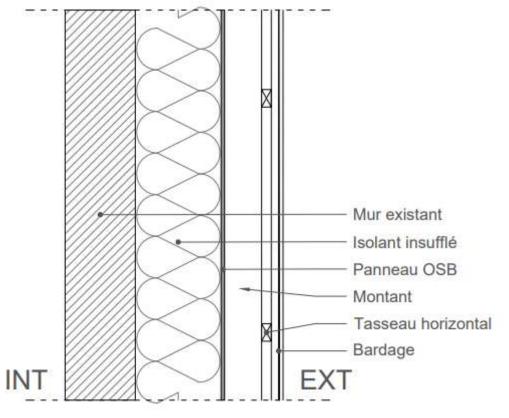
Vue en coupe du BYWalli avec bardage vertical
